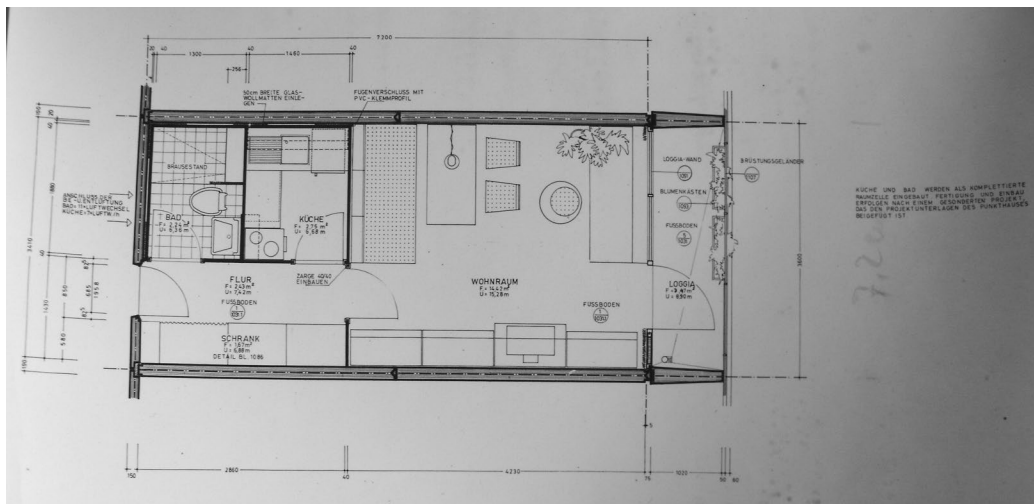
Josef Kaiser, »Großhügelhaus«, Grundriss einer Ein-Zimmer-Wohnung mit Küche und Bad, 1967.
